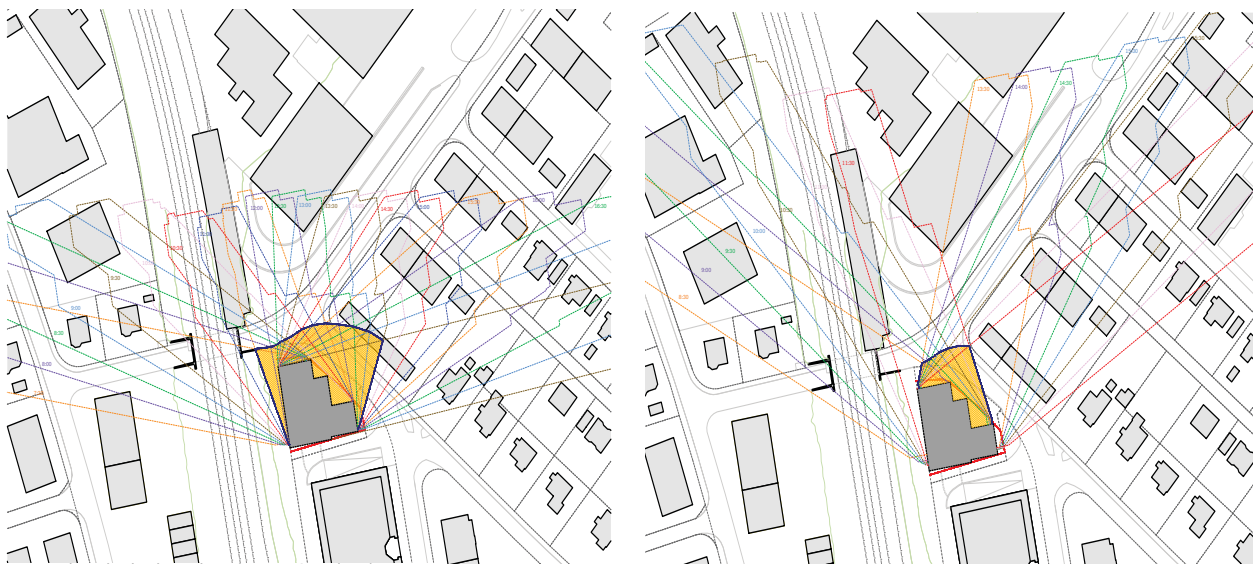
Schattenwurf Tag- und Nachtgleiche min. 4 Stunden (l) und mittlerer Wintergang während min. 5 Stunden (r)
